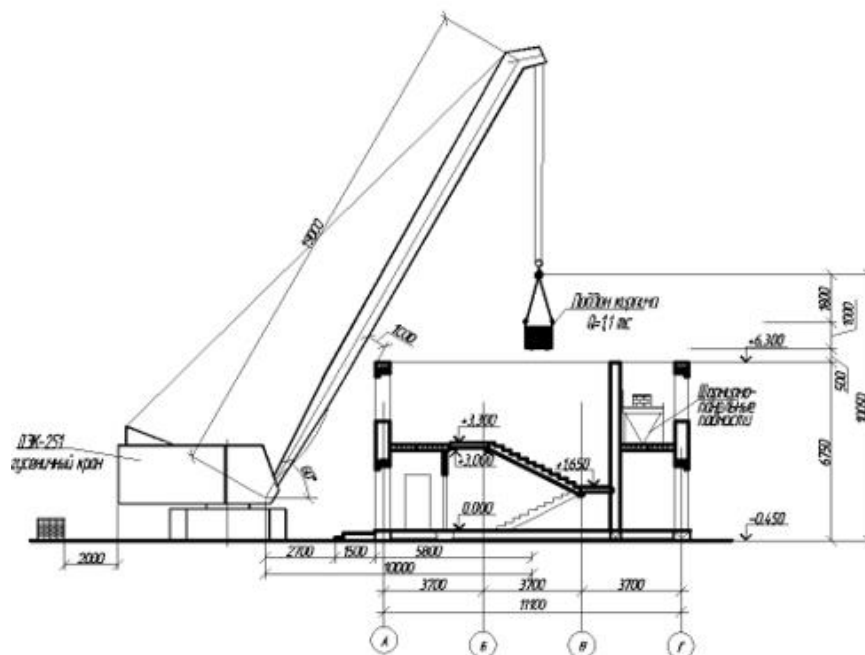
Схема монтажа плиты перекрытия
